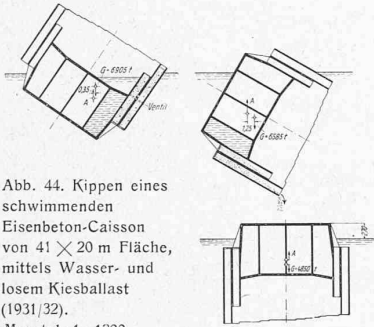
Kippen eines schwimmenden Eisenbeton-Caisson von 41 x 20 m Fläche, mittels Wasser- und losem Kiesballast (1931/32). Masstab 1 : 1200.
